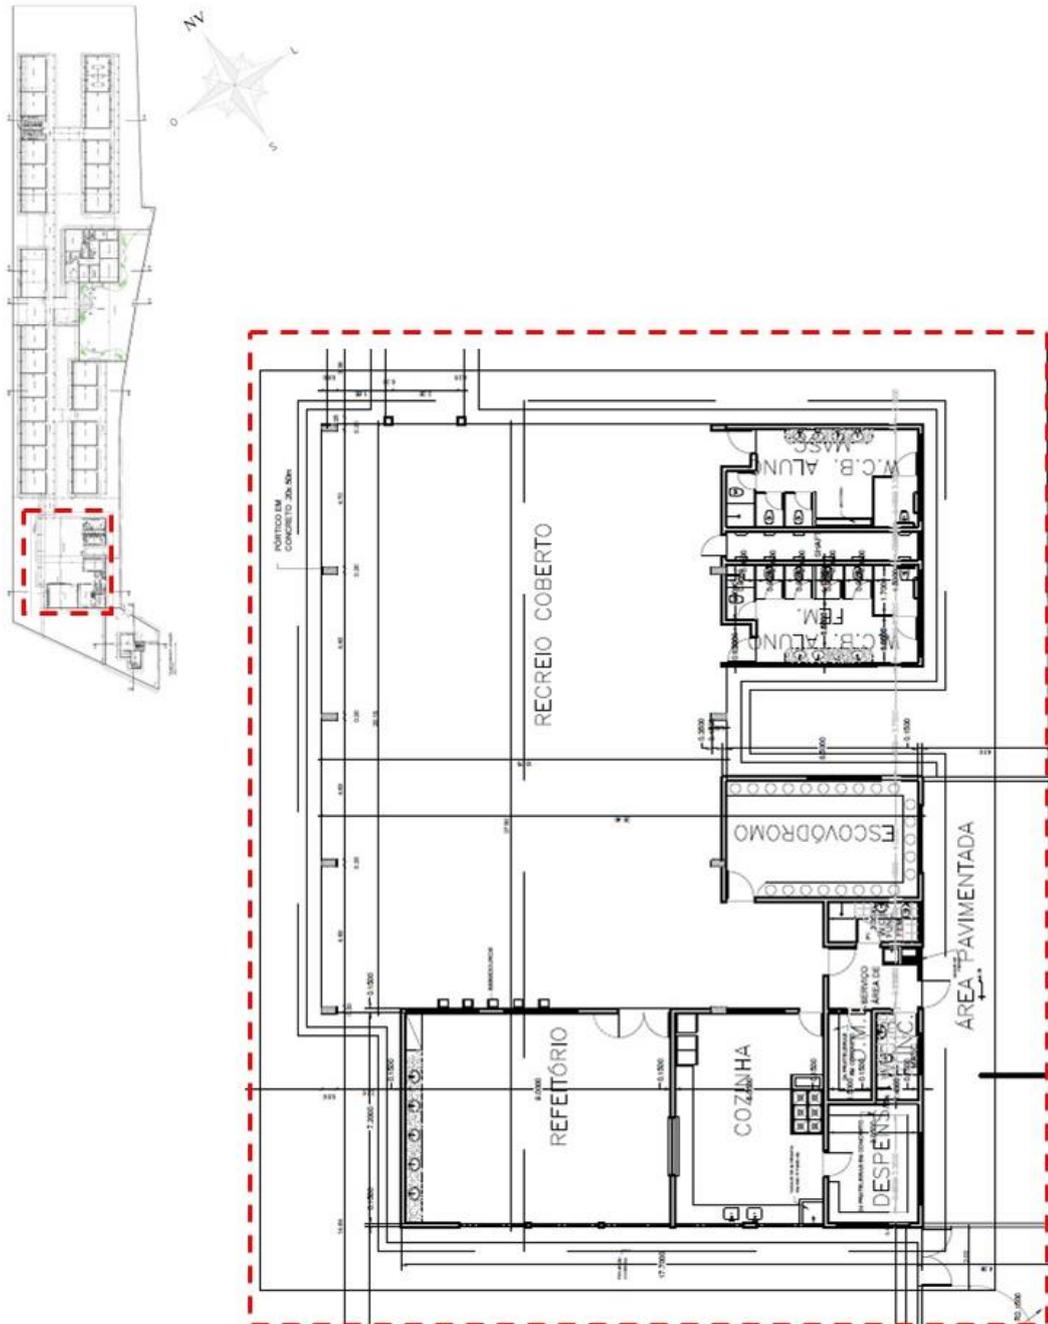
Planta baixa aproximada - casa de apoio (sem escala).
